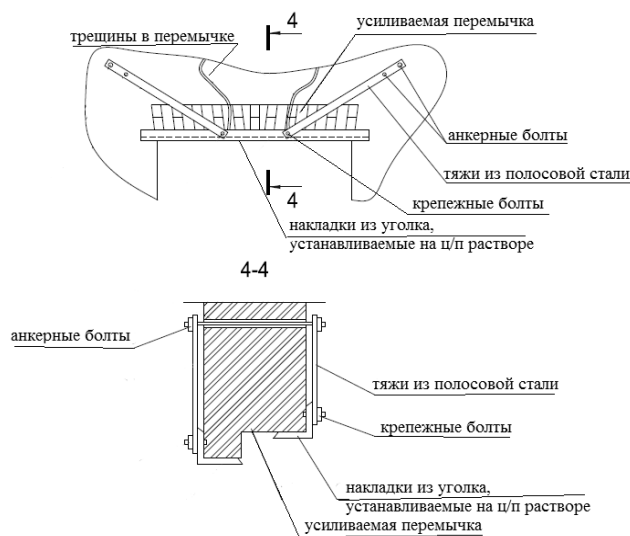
Схемы усиления каменных перемычек стальными пластинами и уголками, соединенными стальной обоймой.
